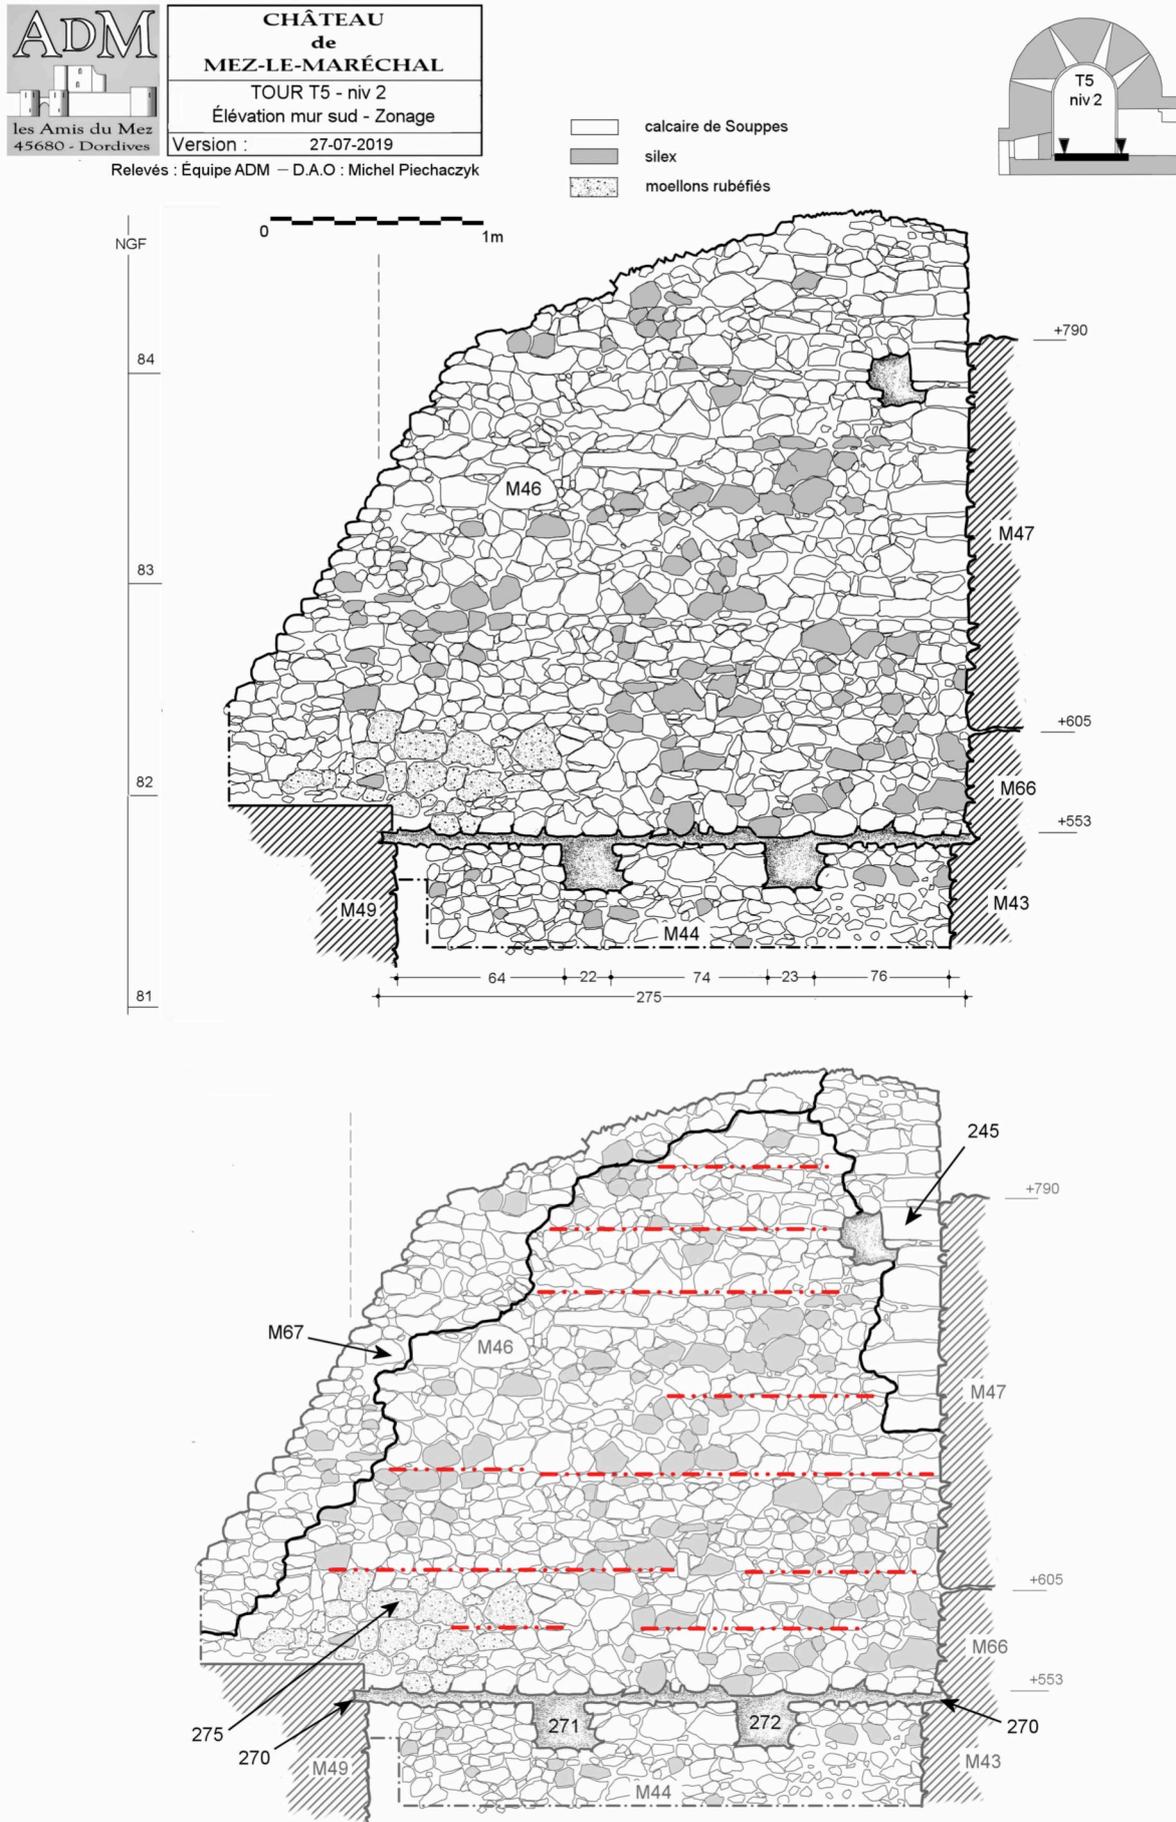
Tour T5 - Niveau 2 - Relevé pierre à pierre du parement intérieur déroulé côté sud (DAO : Michel Piechaczyk / ADM).
